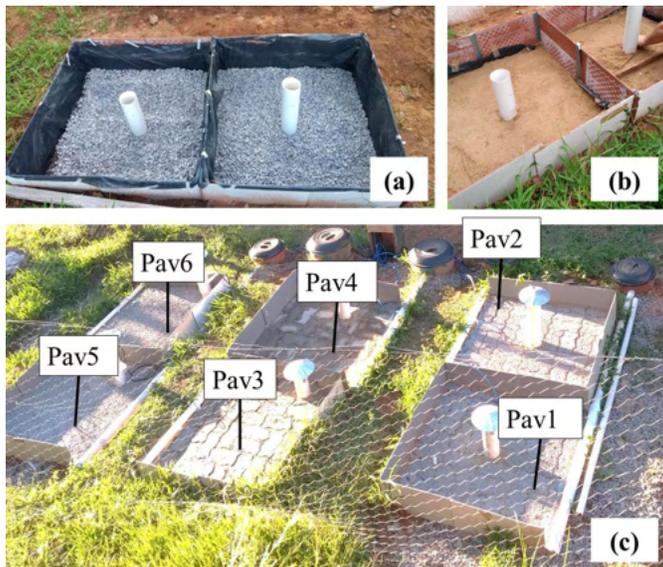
Etapas de construção. (a) colocação da brita; (b) camada de assentamento; (c) revestimentos com blocos intertravados.
